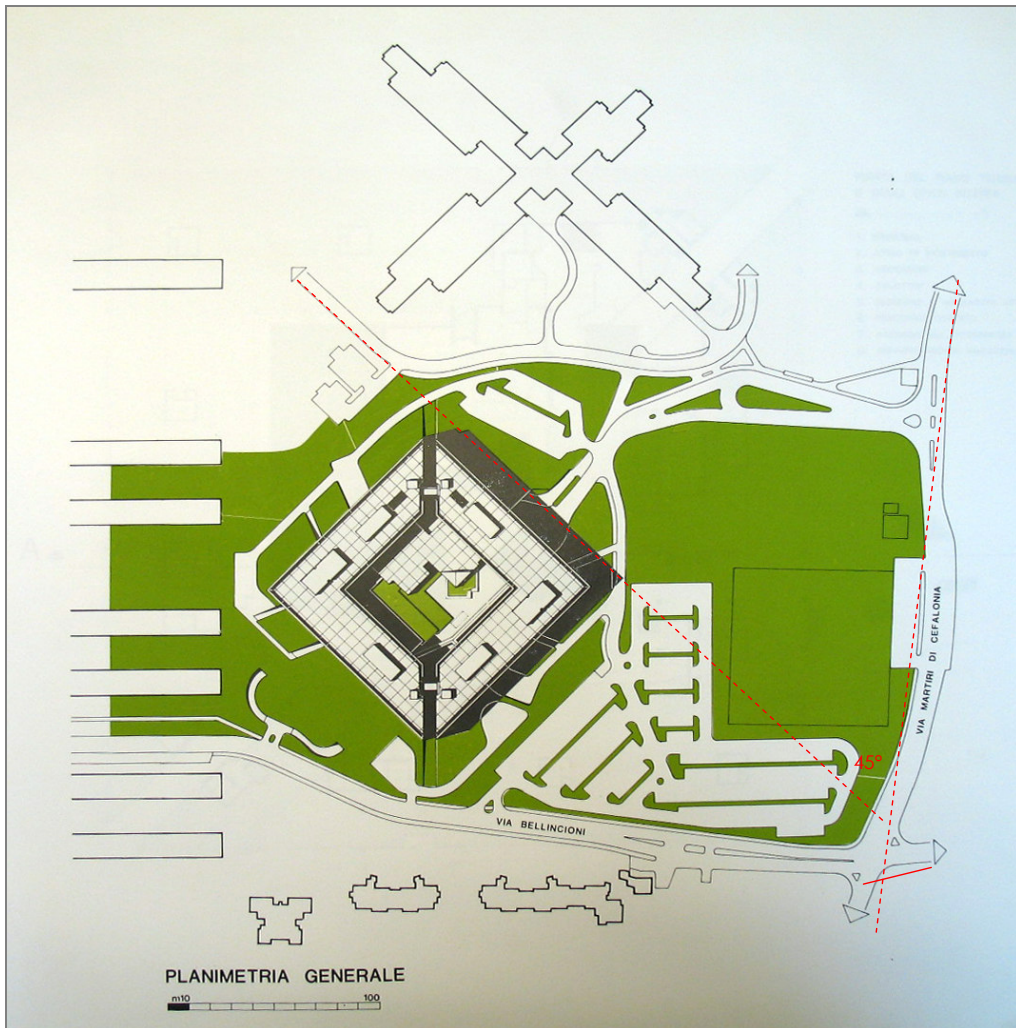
planimetria generale (archivio studio alberti matti ferrari) – rielaborazione f.m.
